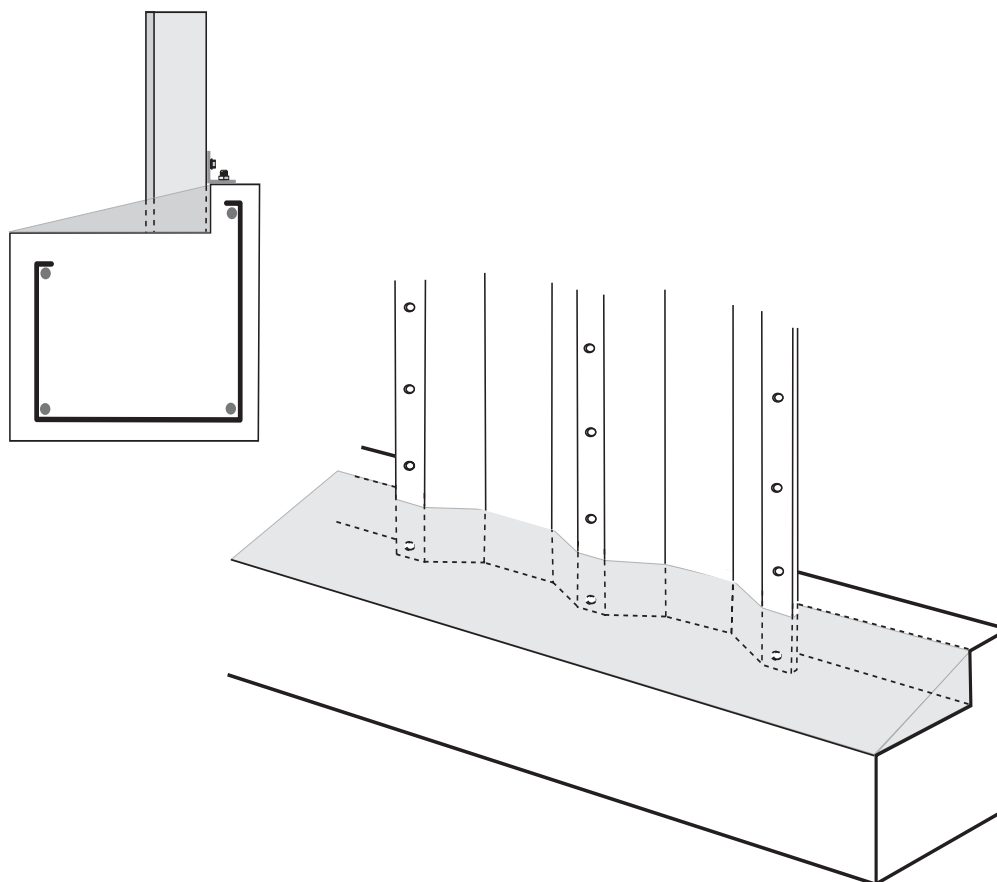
JOINTOIEMENT DES MUR DU BOUT
